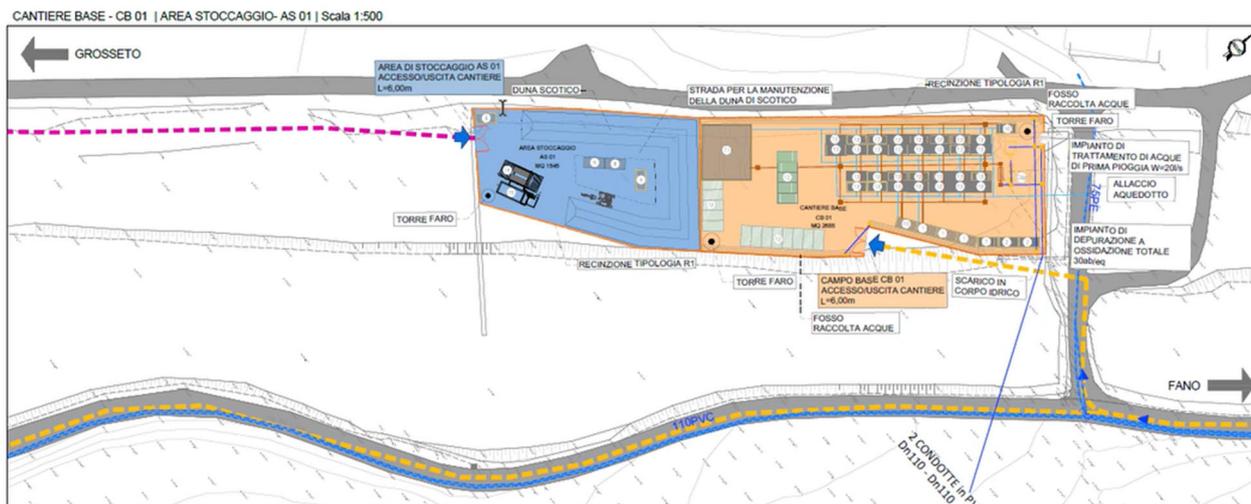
Planimetria di dettaglio - Area di stoccaggio AS 01 e Cantiere Base CB01
